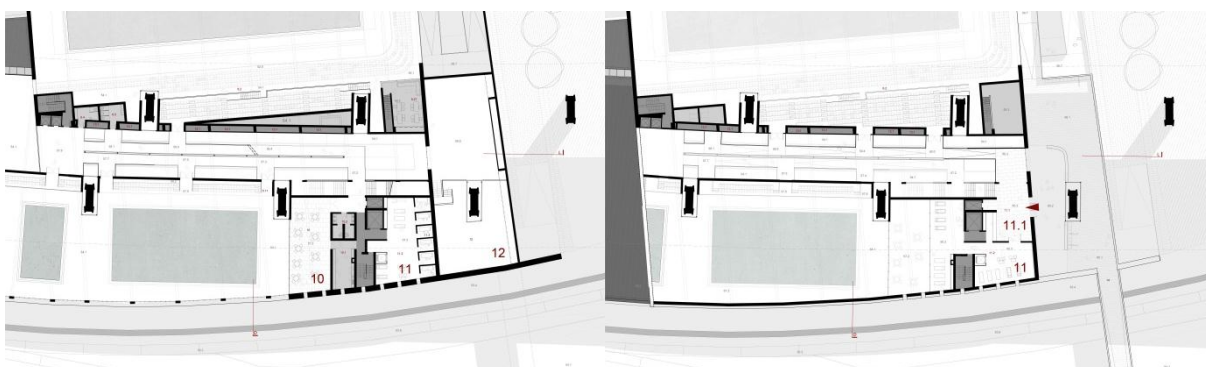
Plantas Piso 1 e 2 – localização dos espaços principais.
